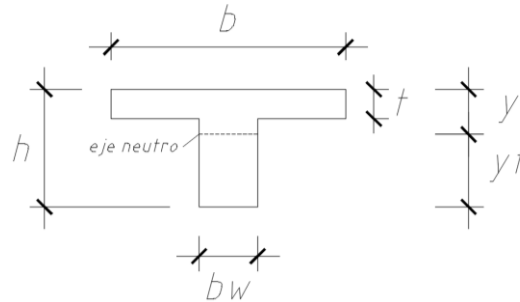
Etiquetas para las dimensiones de la sección de la vigueta
